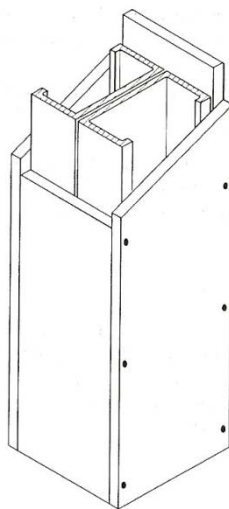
Esquema de enclausuramento de pilar com placa de gesso.
